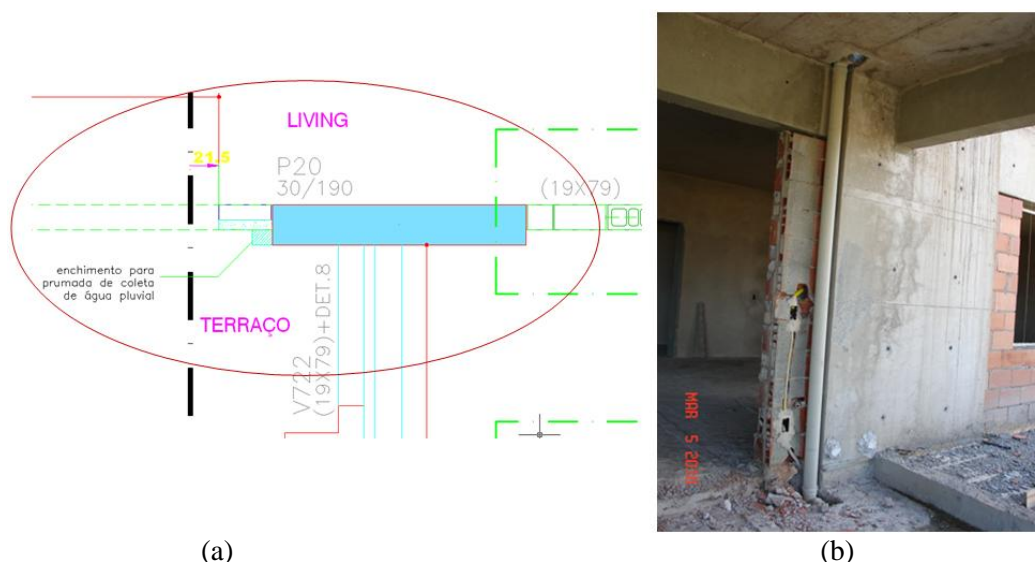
Indicação de enchimento para a prumada de água pluvial: (a) planta de marcação da alvenaria e (b) respectiva execução em obra.
